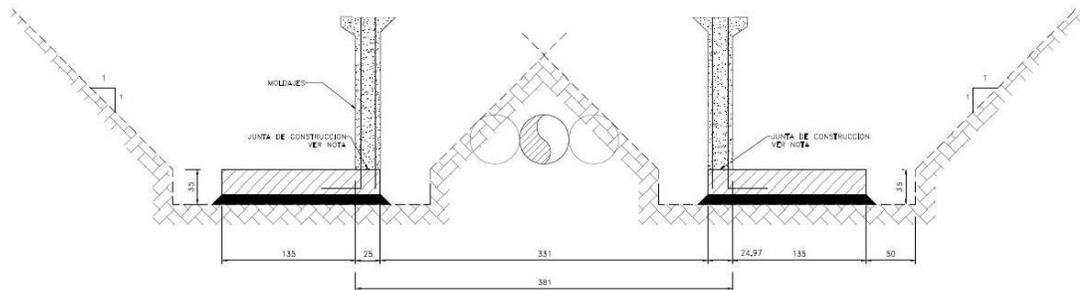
Etapa en que se debe comenzar a rellenar interior y externamente al cajón de hormigón armado.
